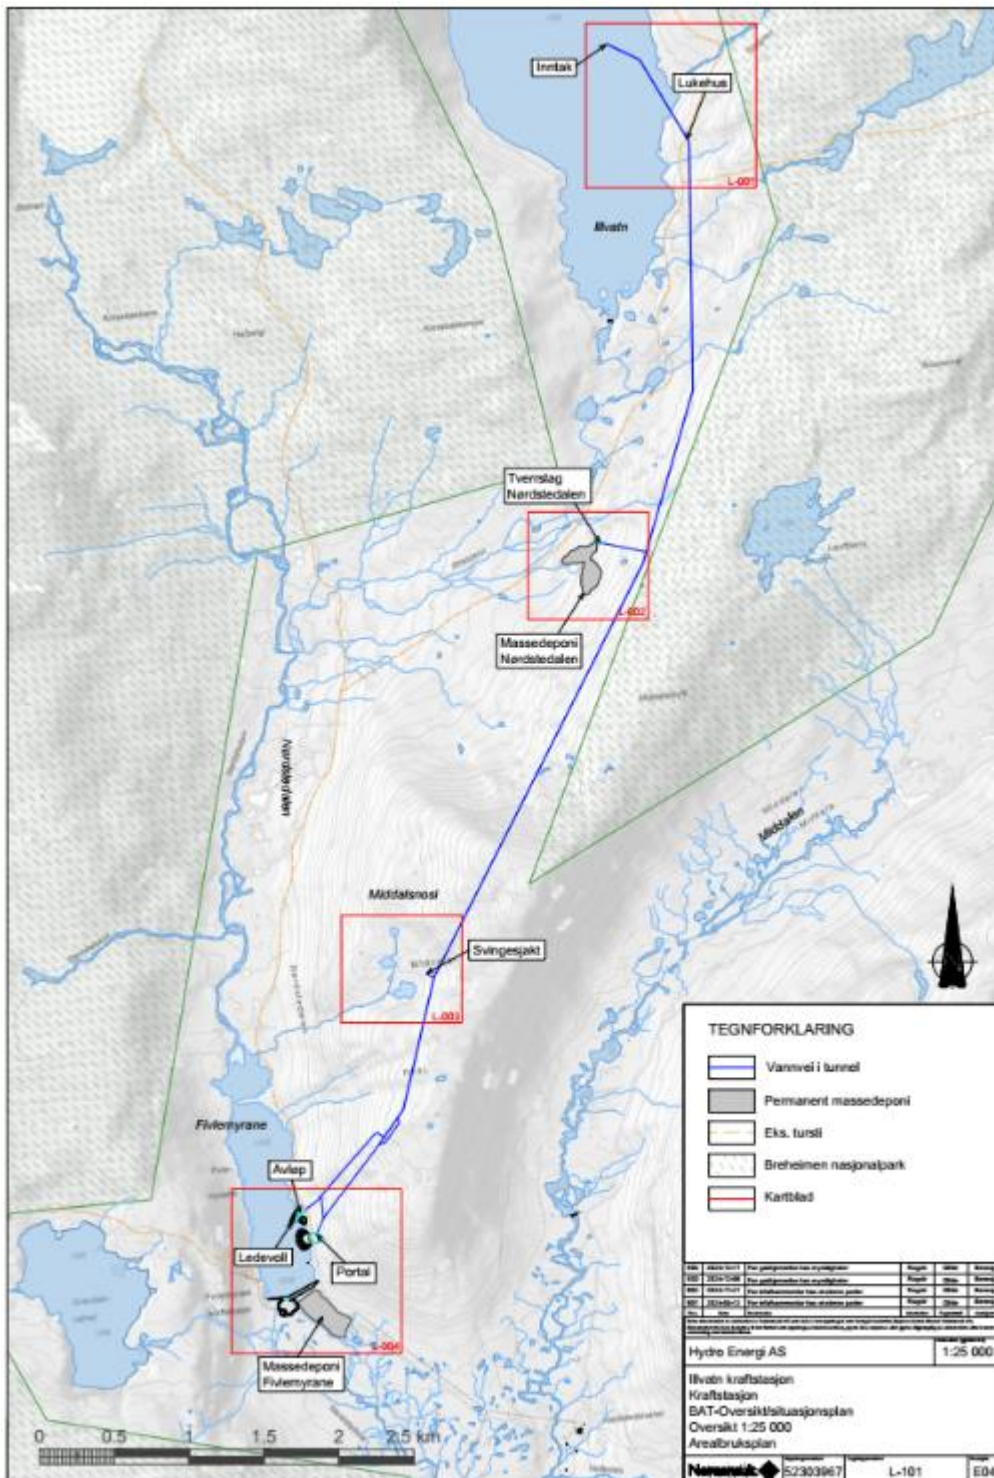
Oversiktskart over det planlagte kraftanlegget med vannvei i tunnel (nord er rotert mot høyre).
